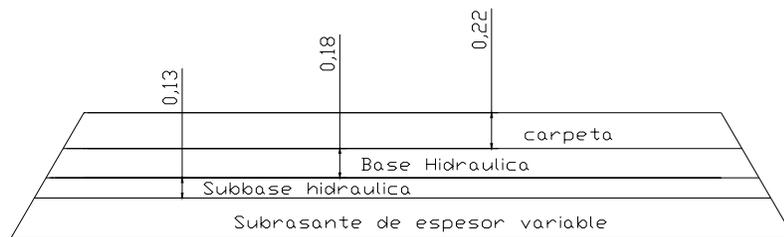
Estructura del pavimento detectada en su evaluación. (Acot. En metros)
